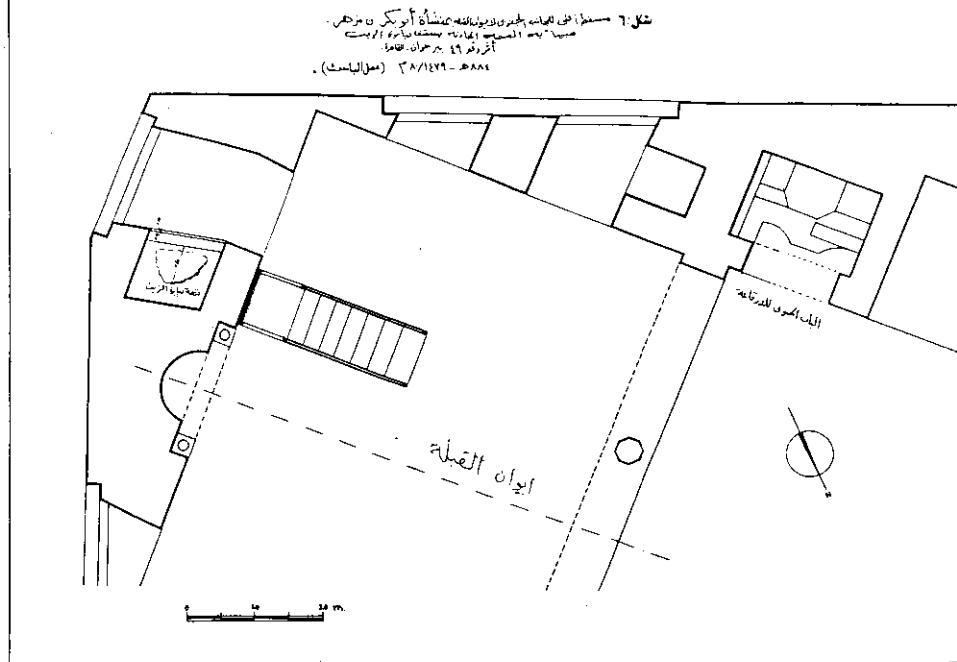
مسقط افقي للبابات الخضراء بمنشأة أبو بكر بن مزهر.
